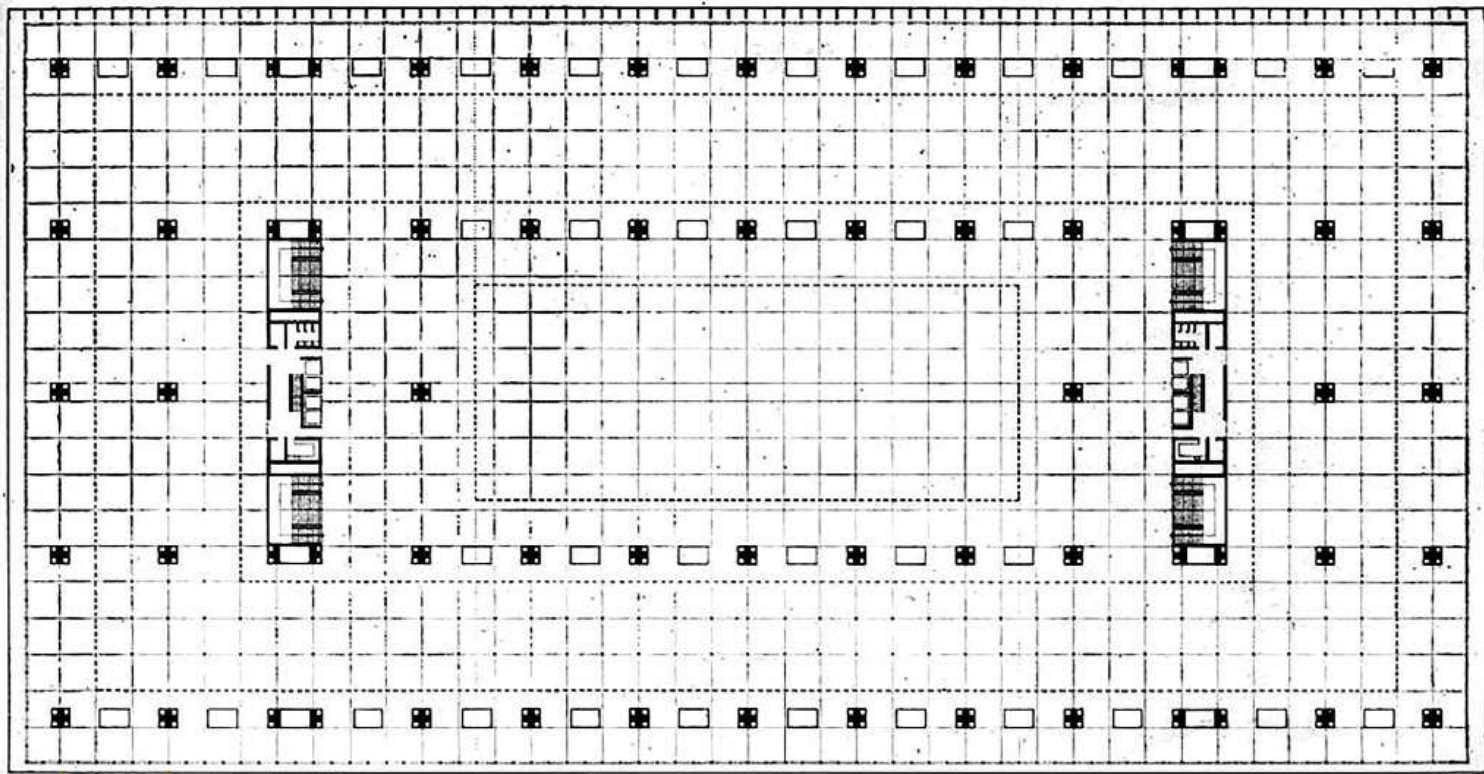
Planta del bloque tipo para el sector de enseñanza. Fuente: La Ciudad Universitaria de Tucumán (1950).
